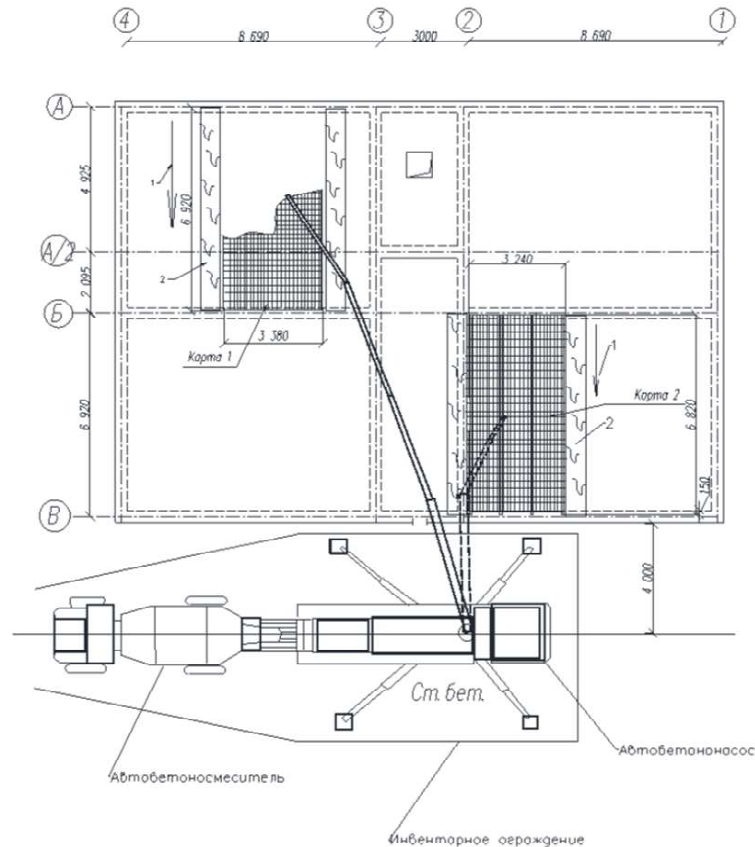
Производство работ по бетонированию плиты перекрытия: 1 – направление бетонирования; 2 – продольный деревянный трап.
